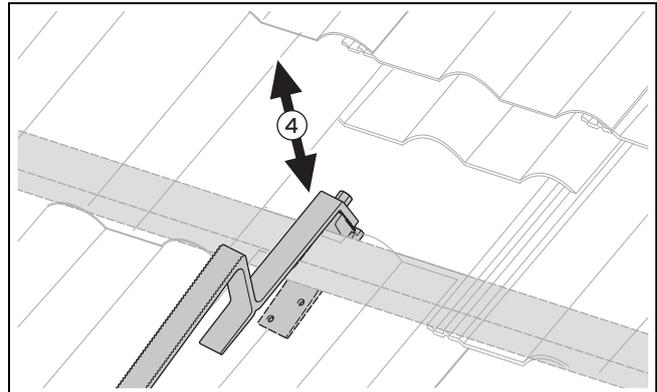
Dachanker Typ P auf der Dachlatte korrekt positionieren
